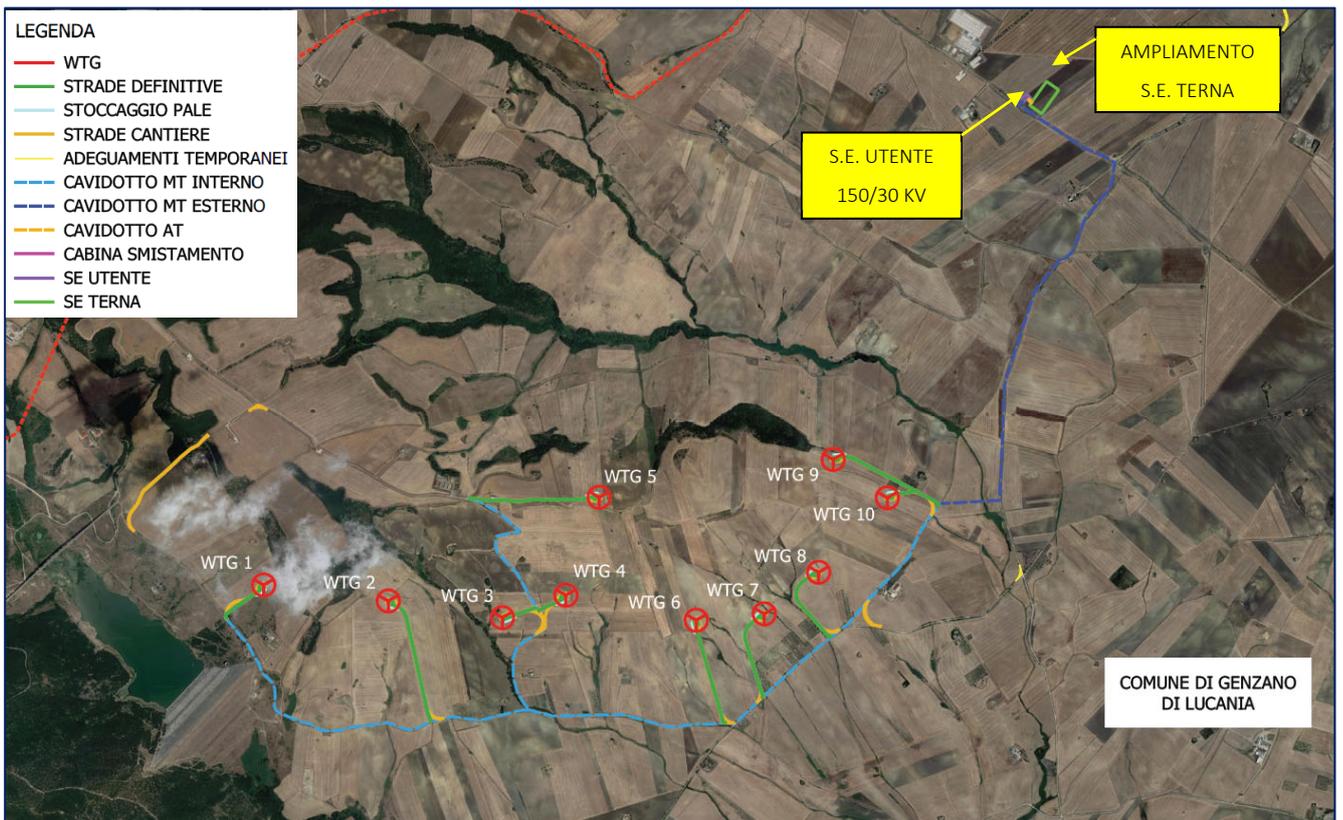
Area di intervento: dettaglio layout di progetto su ortofoto
